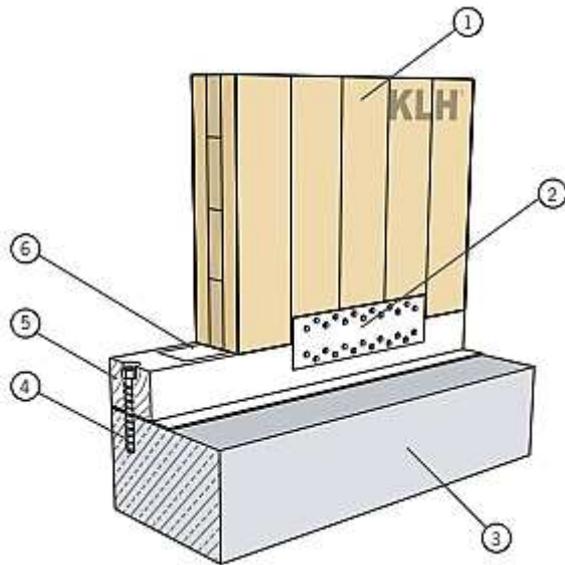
Ligação parede CLT/base em betão (ligação metálica cantoneira) [24]
